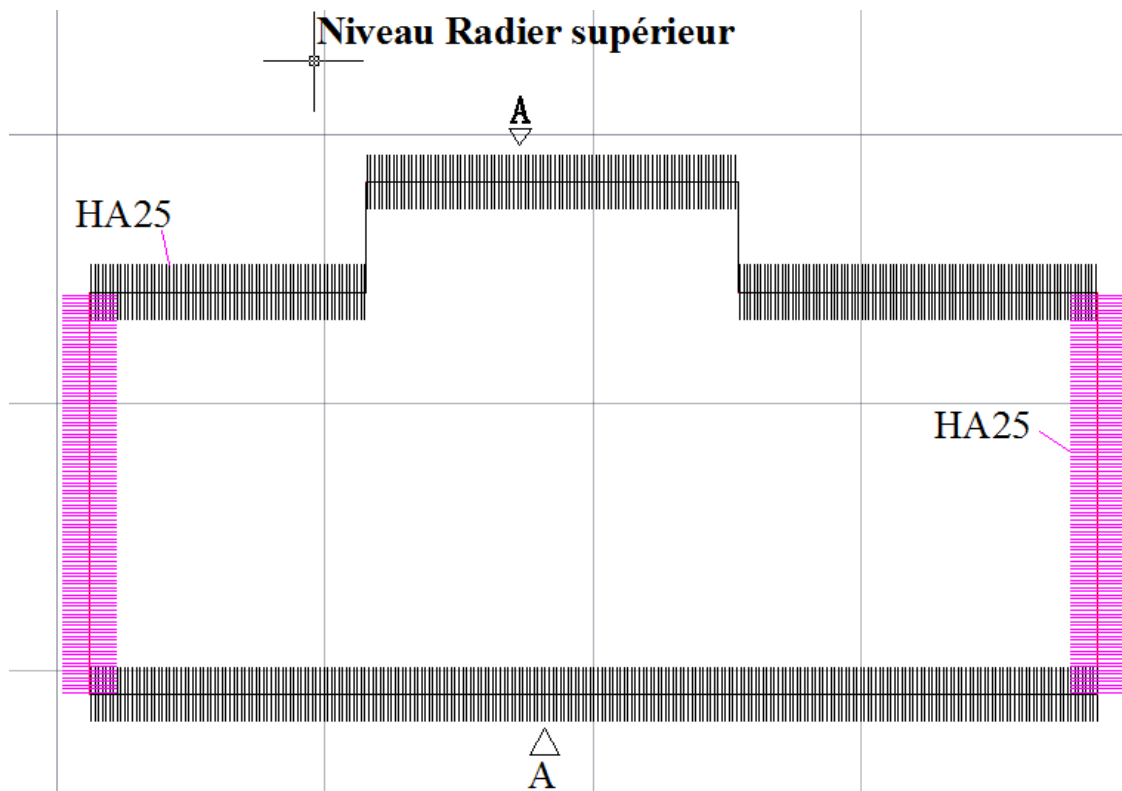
Schéma de ferrailage sur appuis du radier supérieur (Nappe inférieure)
